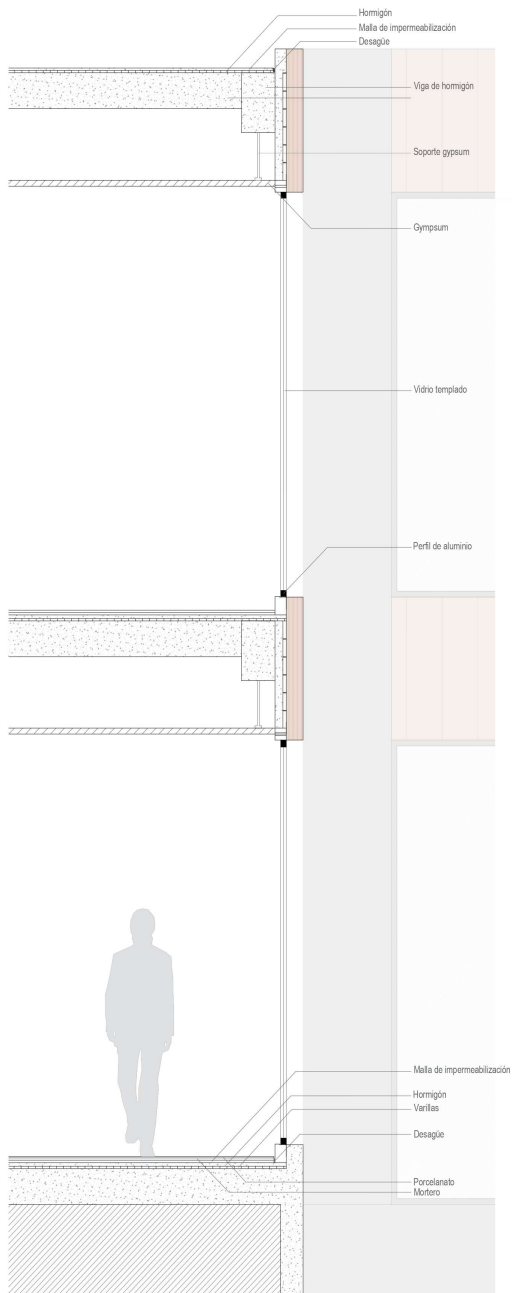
Proyecto final: Corte por Fachada. Elaboración propia.
